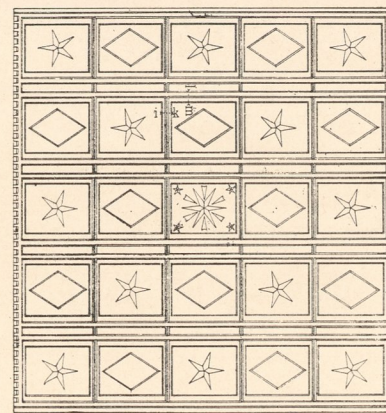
Holzdecke (Tannenholz, Einlagen Eichenholz) im Raume R des Erdgeschosses (Abb. 6).
